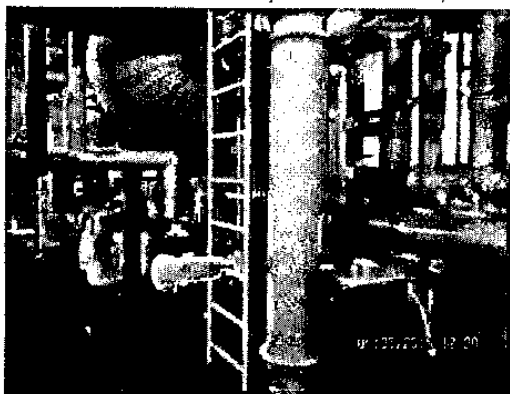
Bateria de compressores geração de frio para o empreendimento.
